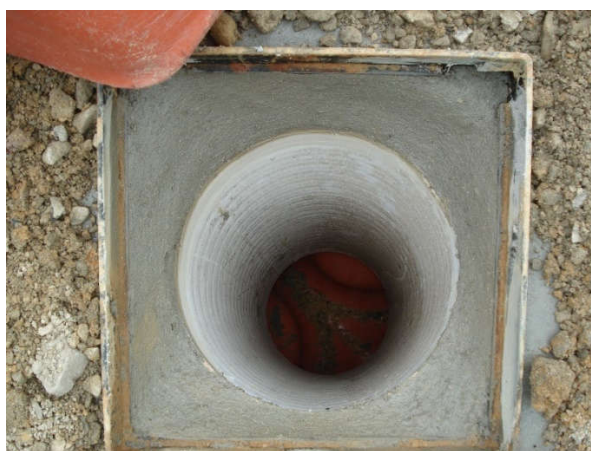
Pormenor de caixa de ramal de ligação após execução de maciço para assentamento da tampa
